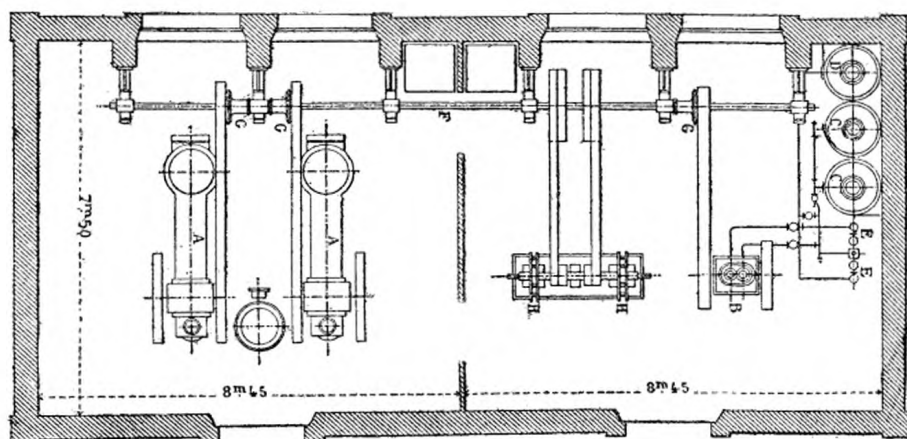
Phare d'Eckmühl. — Plan de la salle des machines.
